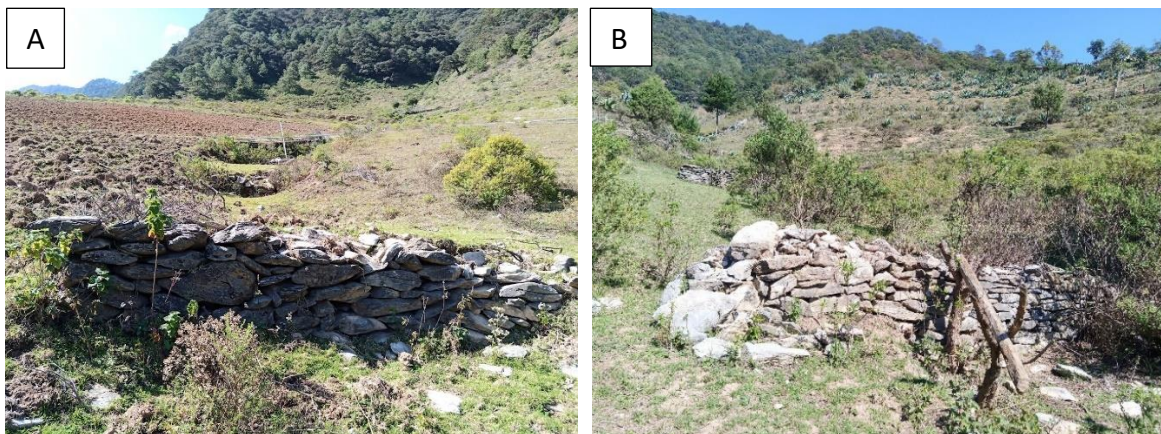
Presas de piedra acomodada en sitio no. 12, localidad de La Barranca: A) Estructura sin vertedor; B) Estructura sin vertedor y empotramiento.
